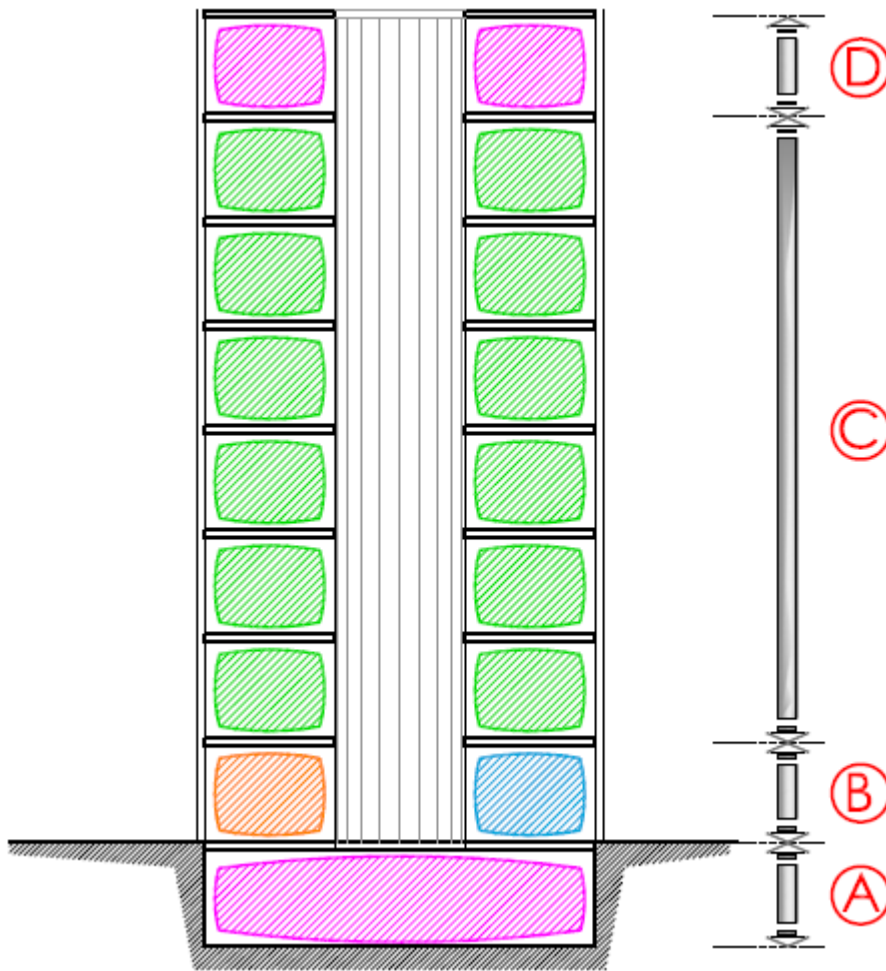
Torre Cilindrica, sezione verticale: distribuzione schematica delle funzioni
